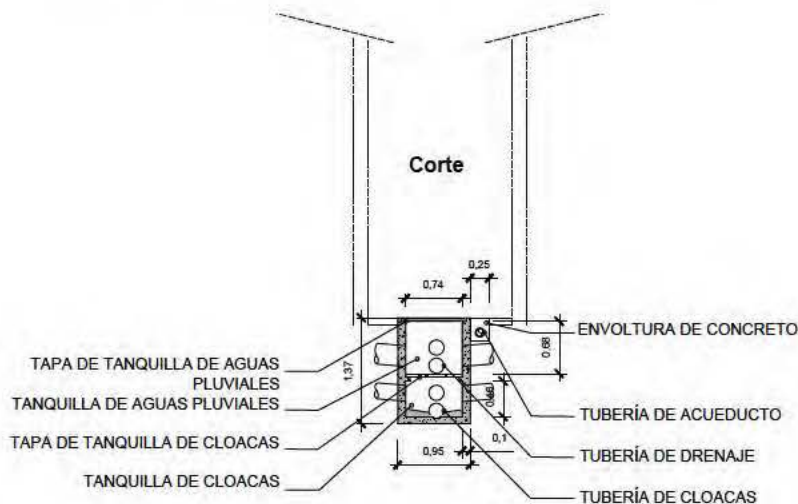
Trazado característico de las tuberías de acueducto, cloacas y drenajes en las escaleras y veredas
